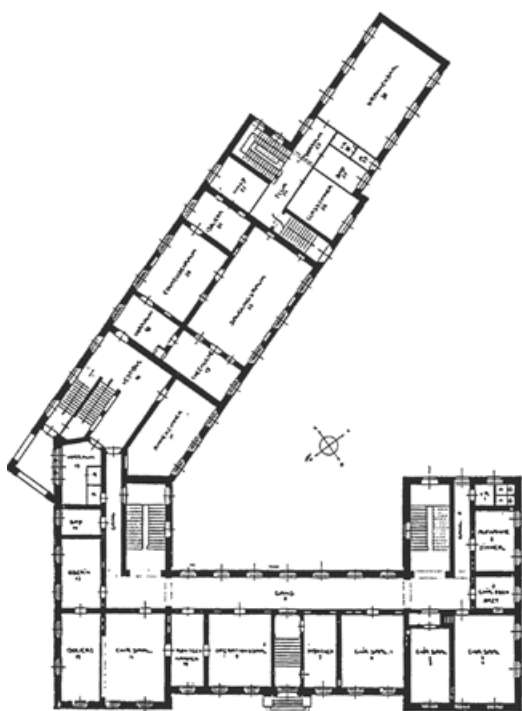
Grundriss Gesamtanlage (Chevalley et.al 2004, S. 398).
